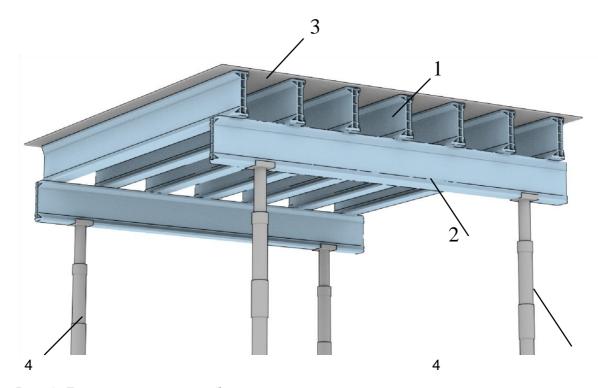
Двухуровневая опалубка междуэтажных перекрытий.
